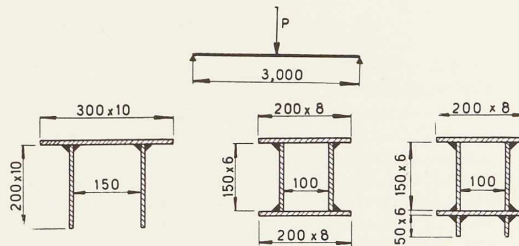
Essais de Patton et Gorbunov sur poutres simplement appuyées.
